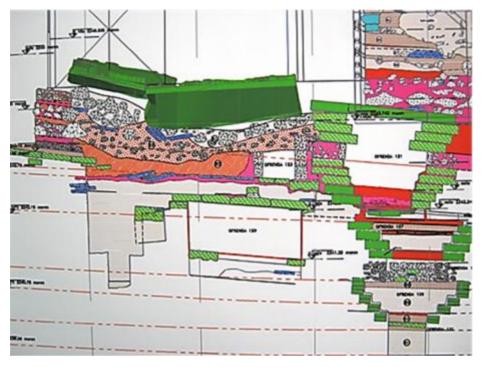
Levantamiento en planta y corte del contexto. Elaborado por el Arquitecto Restaurador Tenoch Medina.
